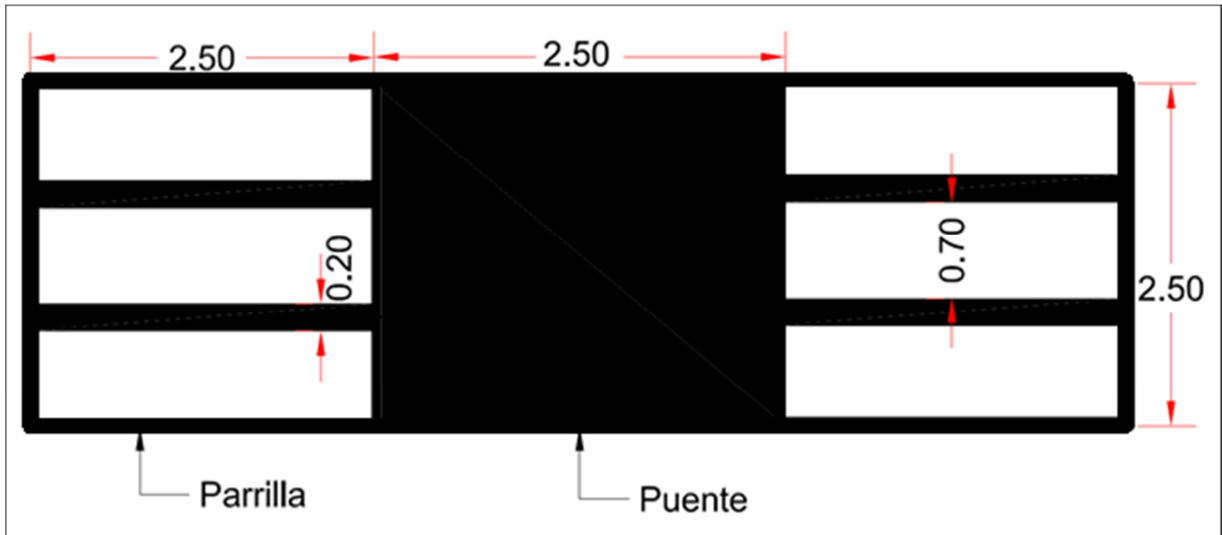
Estructura Parrilla - Puente alternativa II
